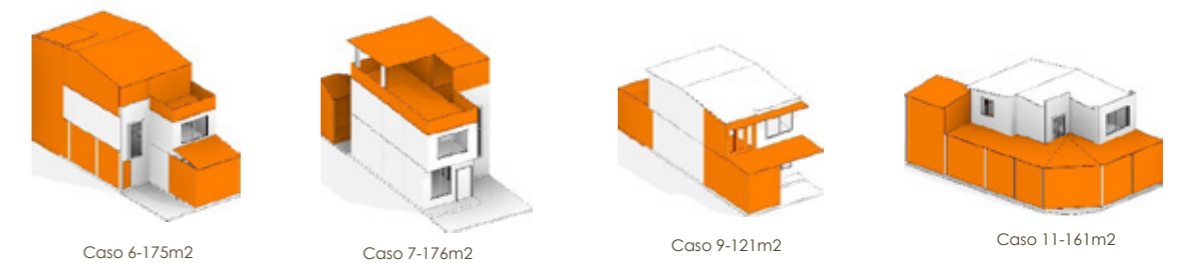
Volumetrías de vivienda comercio. Fuente: autor.
